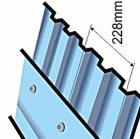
Colocación de los purlings según la distancia entre apoyos
